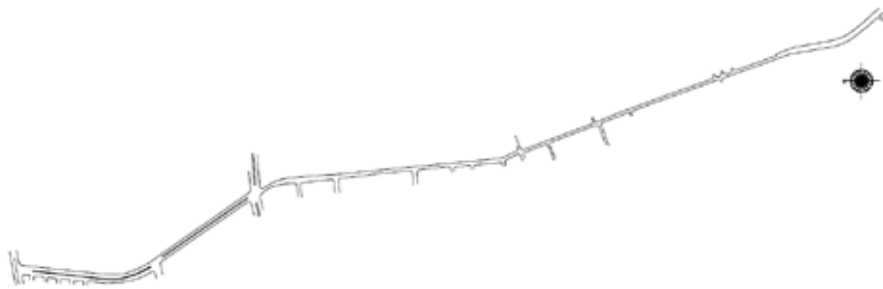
Plano de planta de la Av. Simón Rodríguez.
